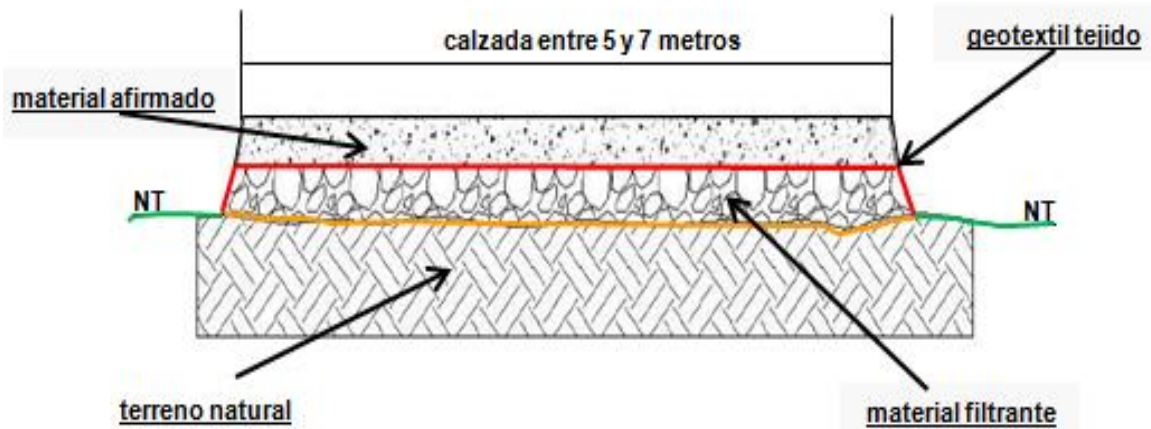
Tipo de la obra de drenaje – subdrenaje
